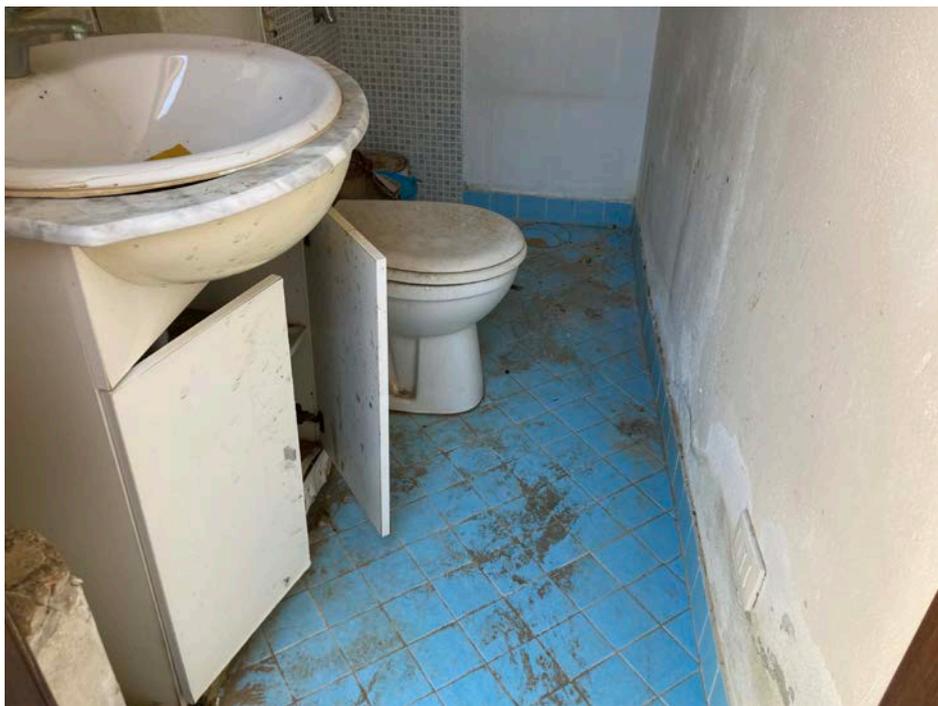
altra veduta del locale wc abusivo al Piano 1°
